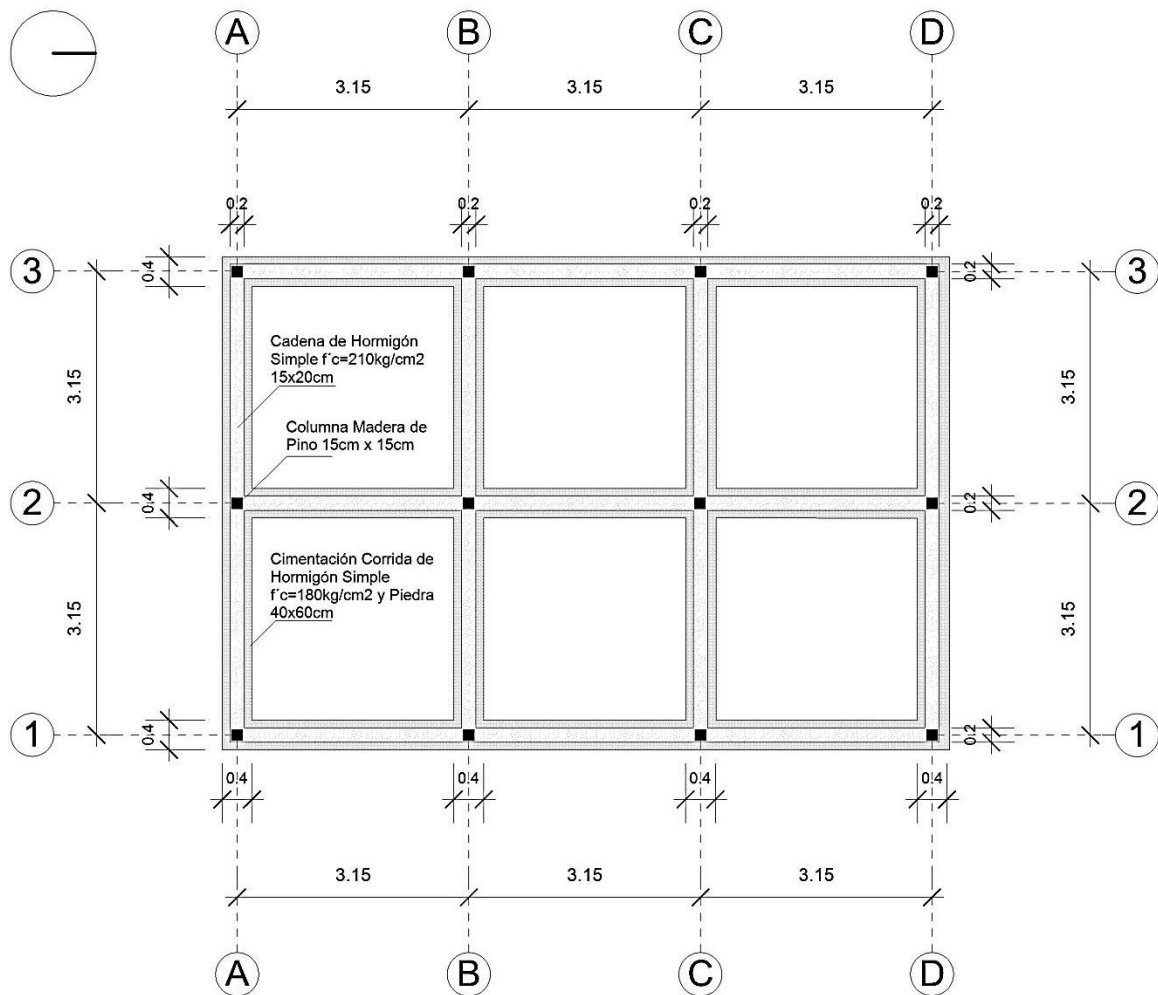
Planta de cimentación de la vivienda propuesta, escala 1=100. Autor: Paúl Rivas Rivas.
